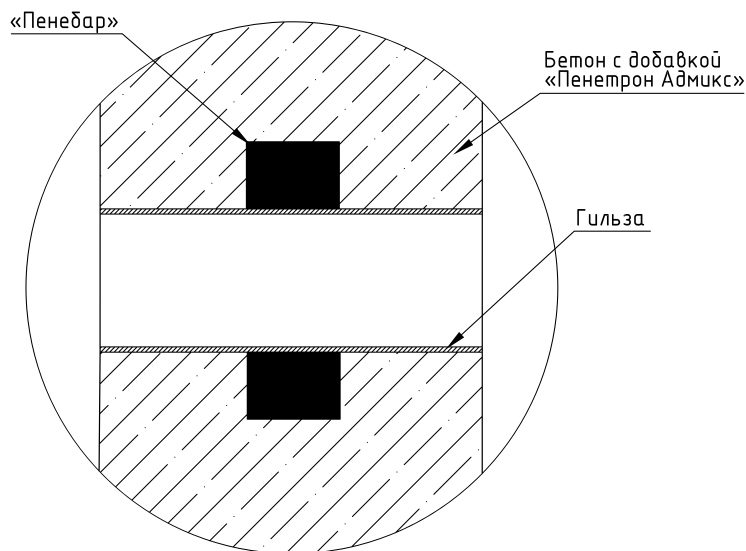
Схема гидроизоляции ввода инженерных коммуникаций на этапе строительства
